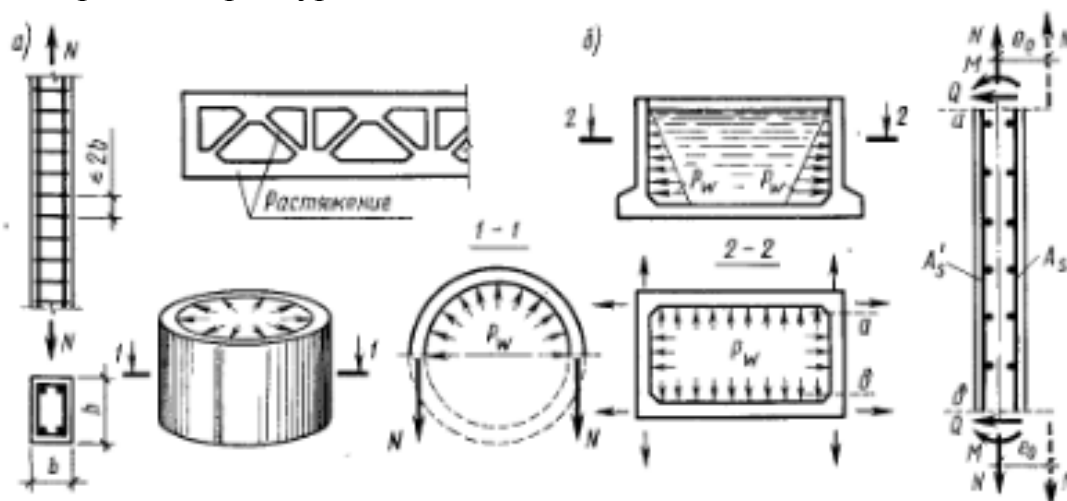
Армирование центрально- (а) и внецентренно (б) растянутых элементов.
